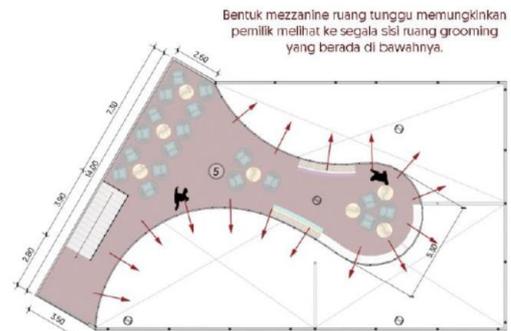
Denah area *grooming* dan mezanin ruang tunggu
